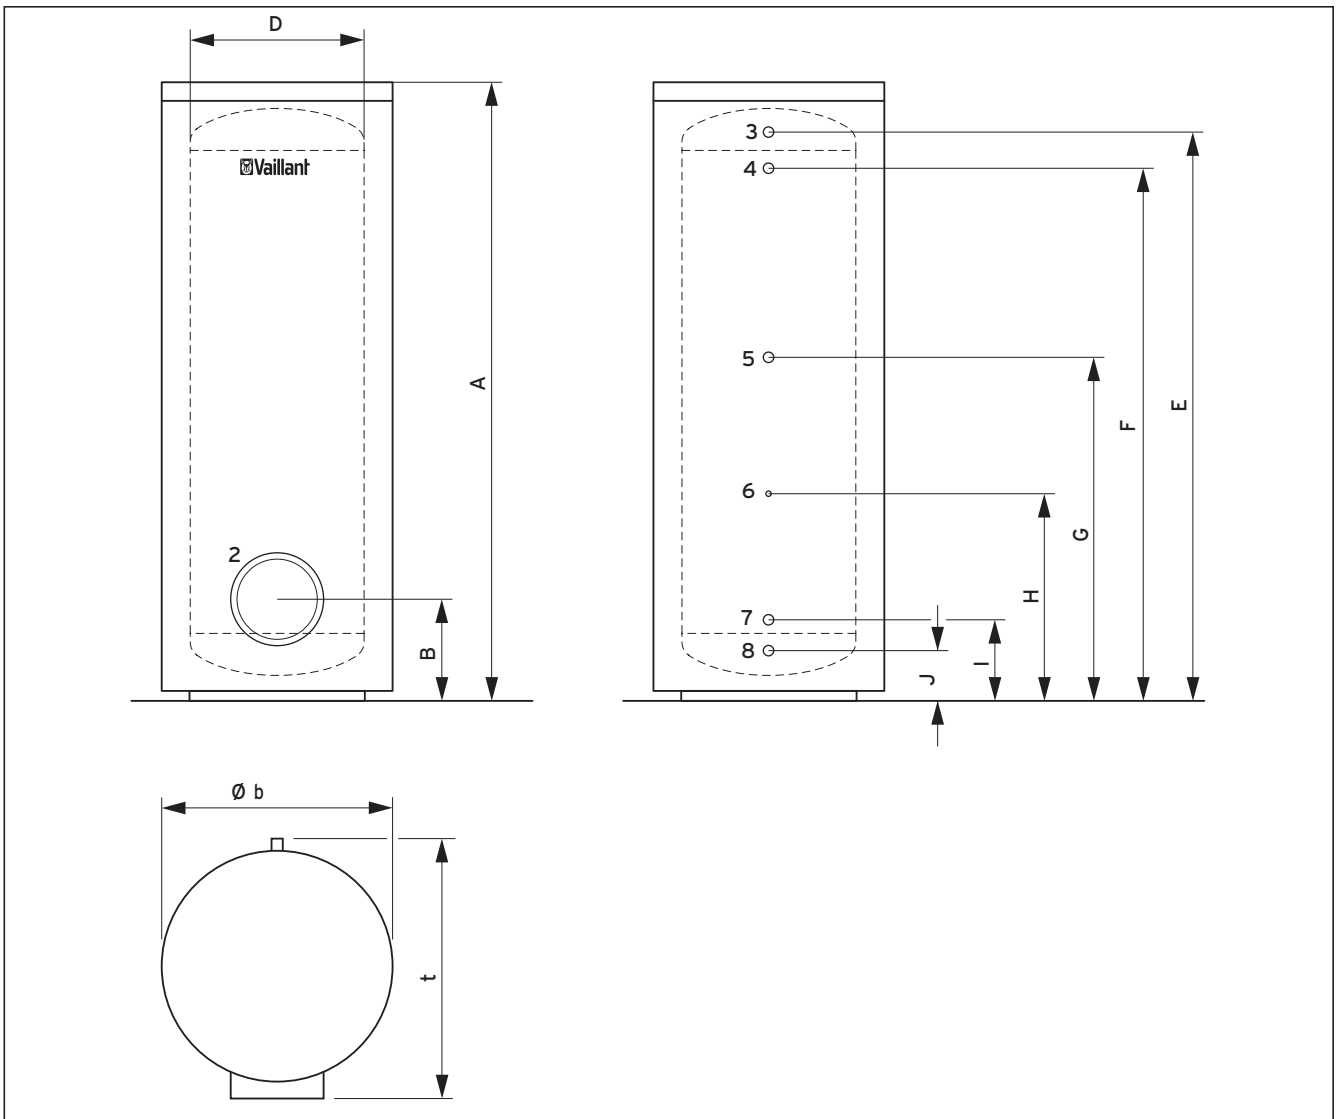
Dimensioni degli apparecchi e dei collegamenti VIH RW
